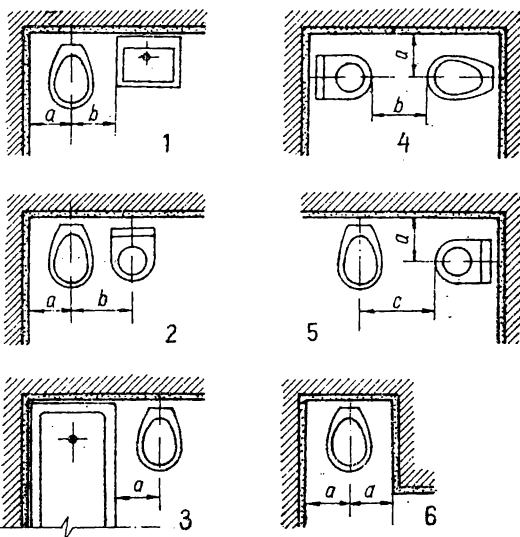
Distanțe minime între closet și alte obiecte sanitare :
